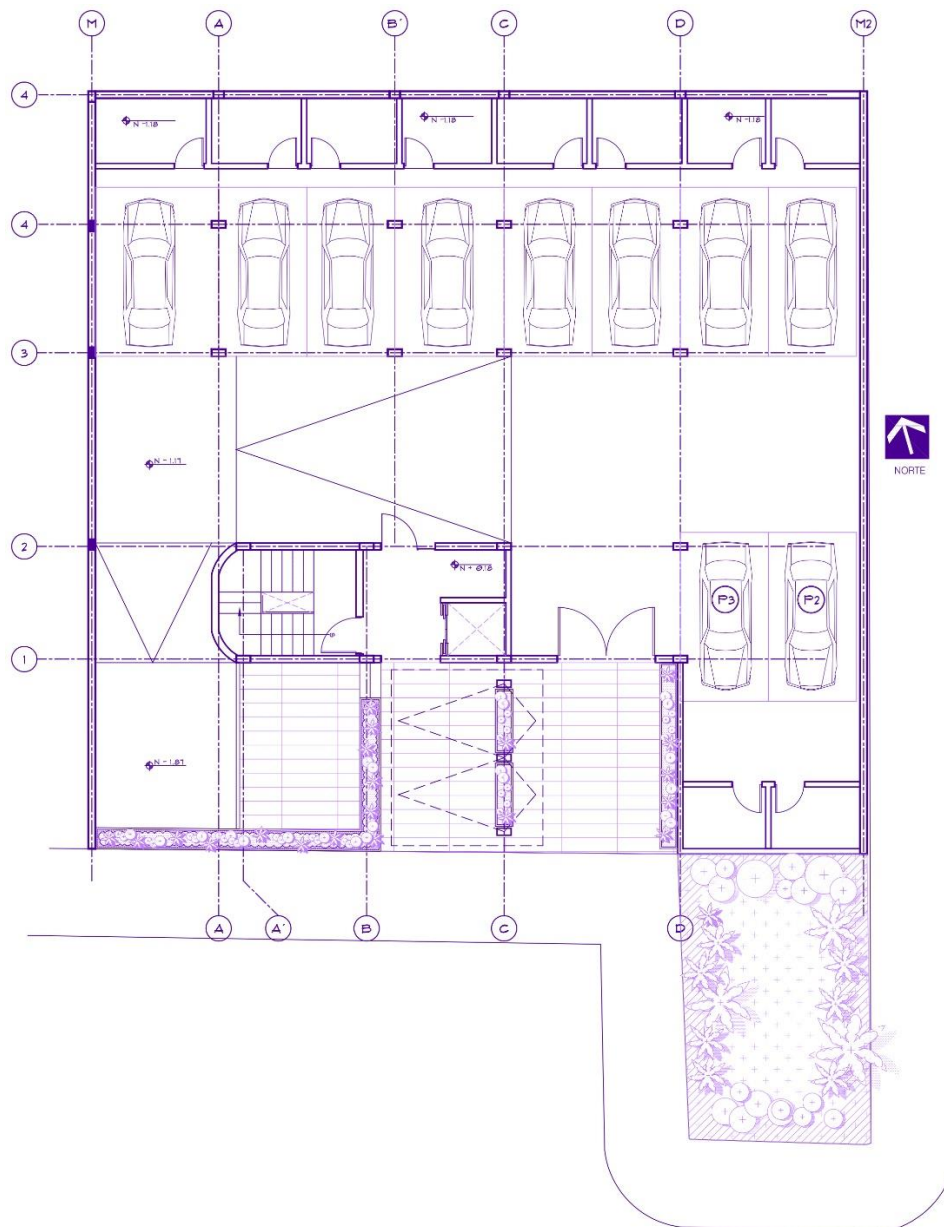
Planta Subsuelos – Elaborado por: Alejandro Albarracín.
